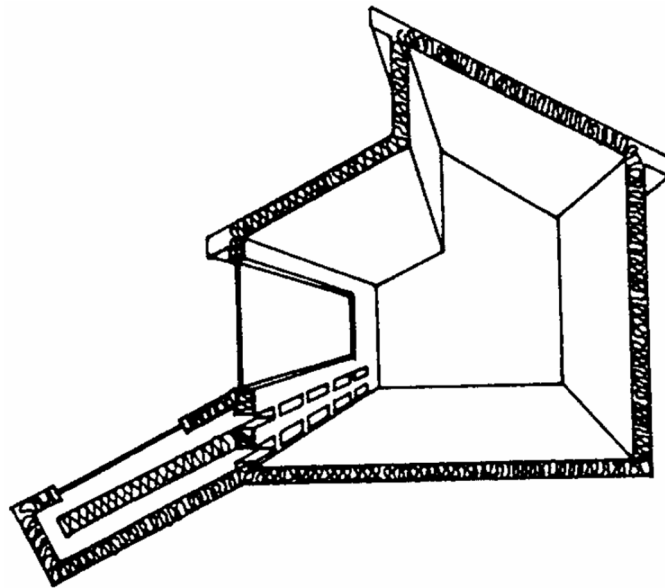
Termostifão colocado abaixo do pavimento [5]
